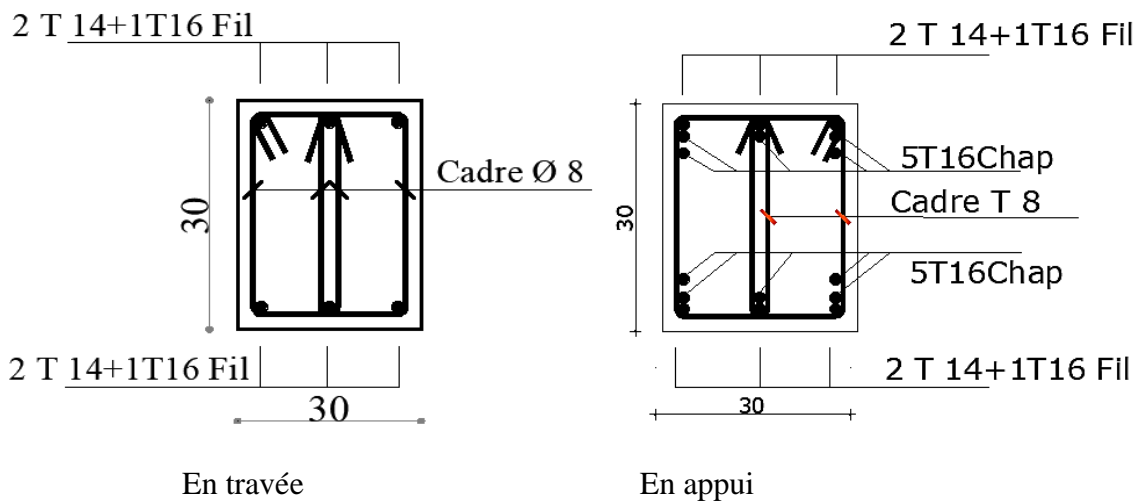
Croquis du ferrailage de la poutre secondaire
